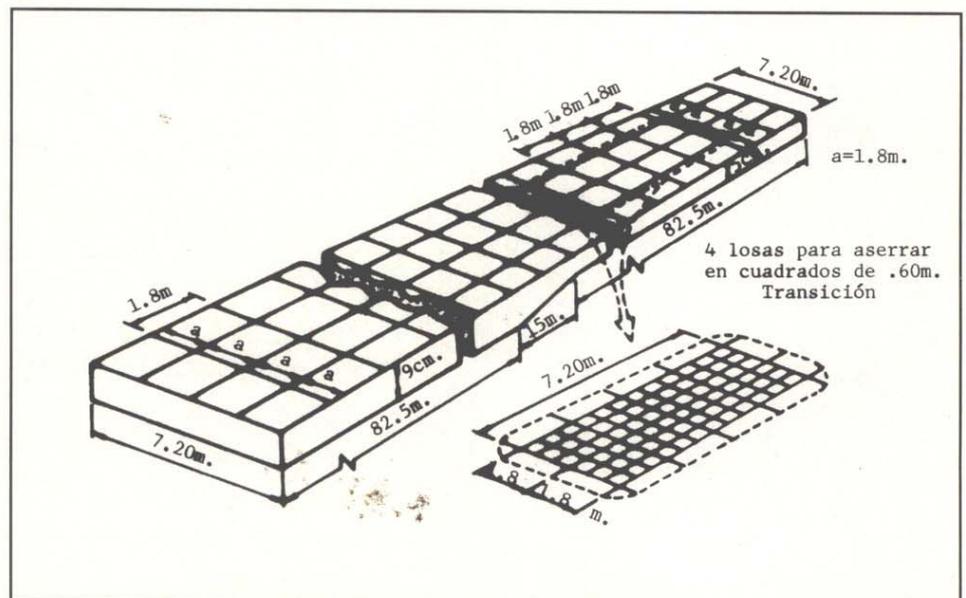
Proyecto experimental de refuerzo Louisville, Kentucky
